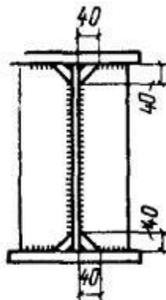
Примыкание ребер жесткости к элементам сечения сварной балки
